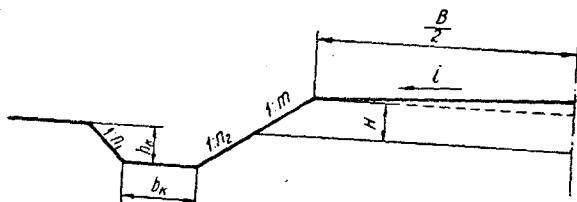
5. Схема для расчета поперечного равновесия грунтовых масс
